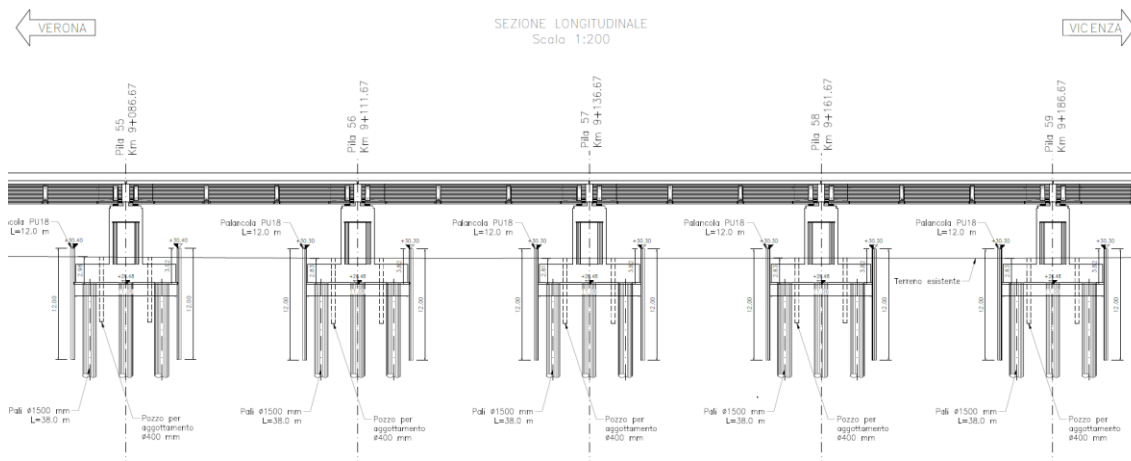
sezione longitudinale da pila 55 a pila 59 (finale)
